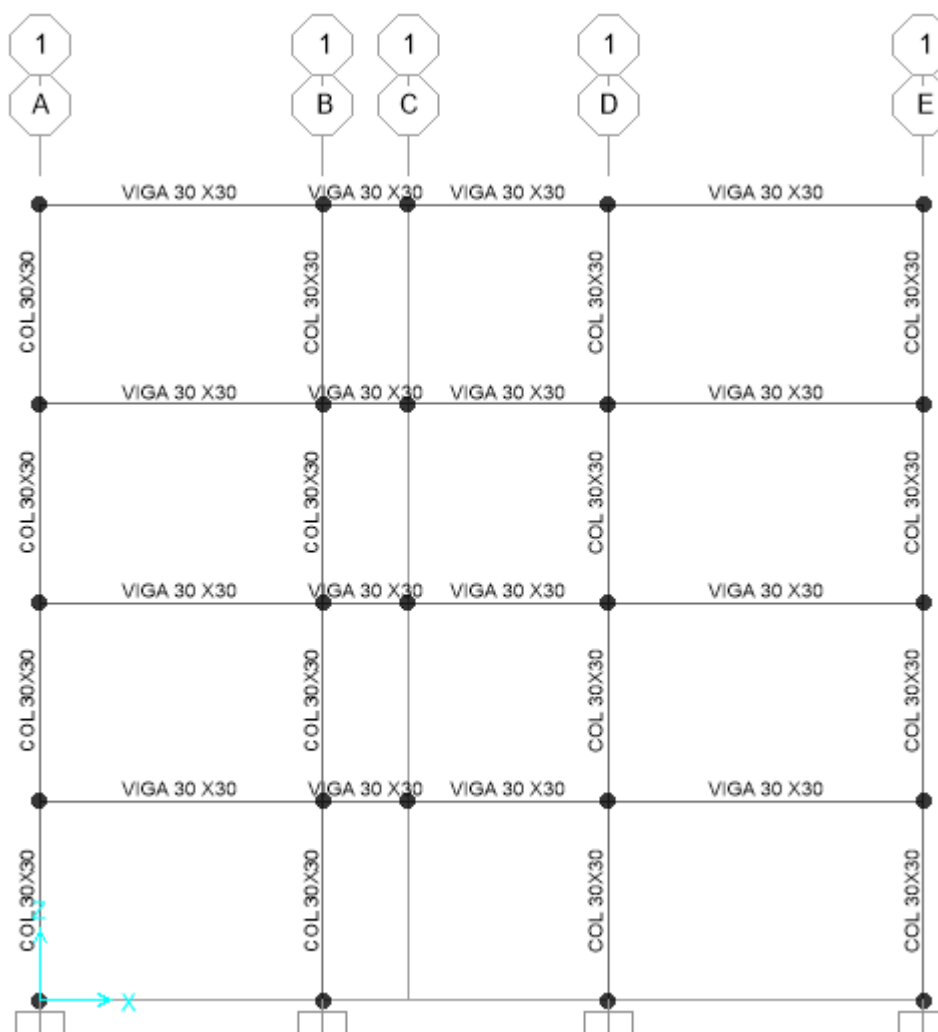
Vista en alzado secciones de columnas y vigas tomado de modelo SAP2000. (Fuente:
